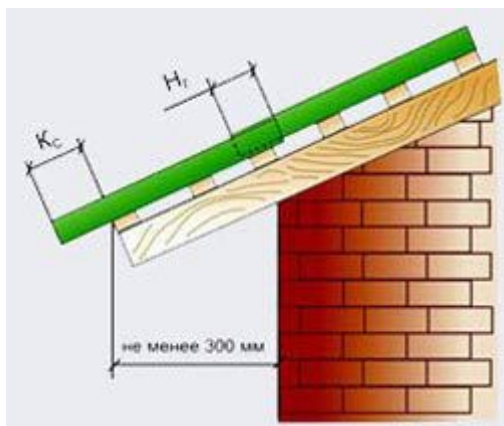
Карниз кровли из профнастила: Нг - нахлест горизонтальный; Кс - карнизный свес.
